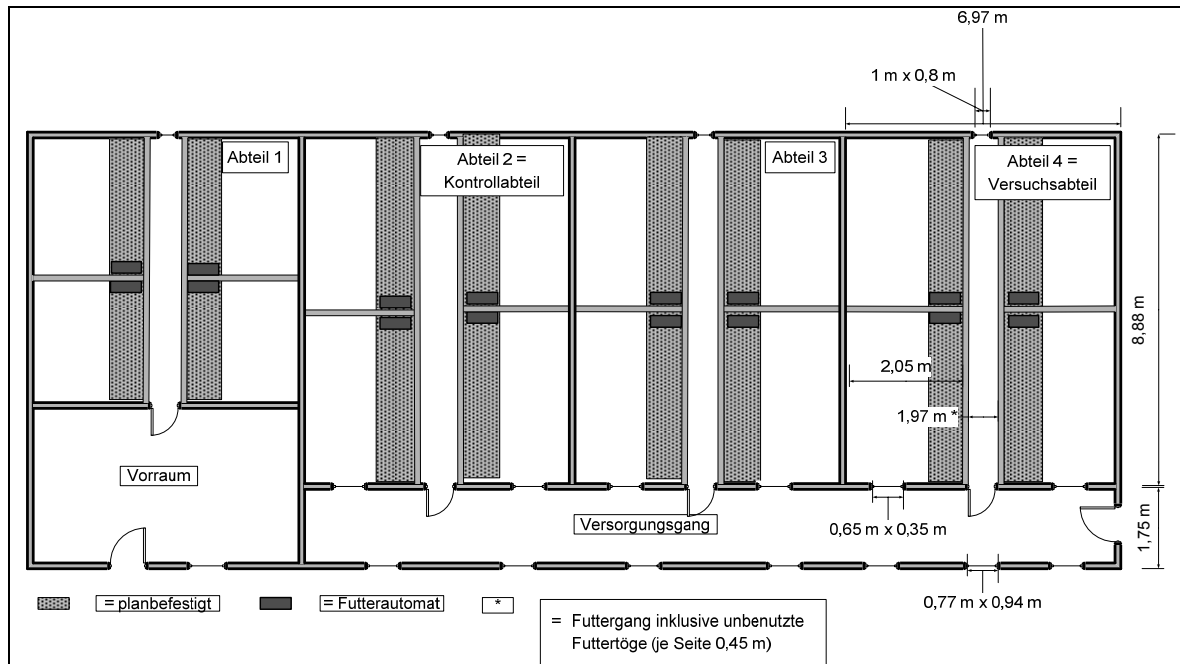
Grundriss des Versuchsstalls an der Lehr- und Forschungsstation Frankenforst
